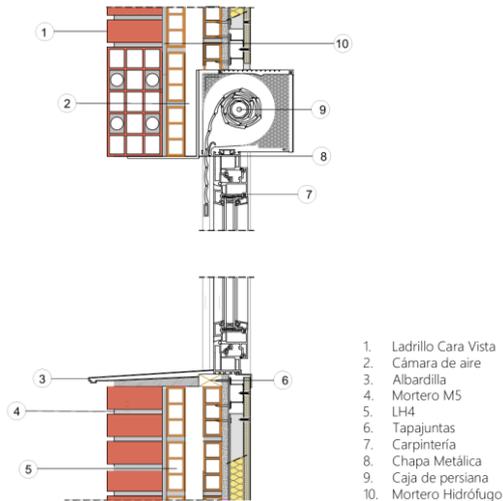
Detalle Carpintería Exterior. Fuente: Propia
